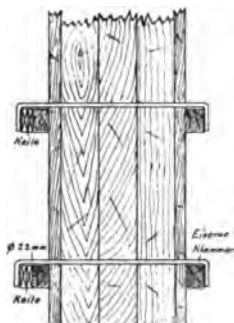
Säulenschalung mit Eisenklammern zusammengehalten.
